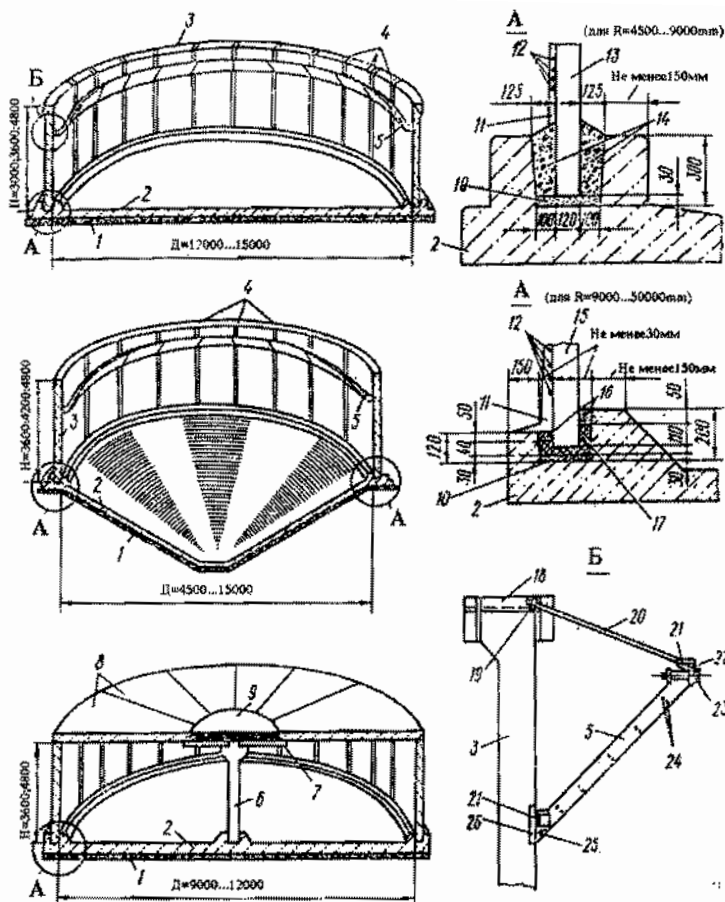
Конструктивно-монтажные схемы цилиндрических емкостных сооружений из типовых унифицированных сборных элементов и деталей: а - радиальные отстойники; б - двухъярусный отстойник или осветлитель; в - резервуар; 1 - бетонная подготовка; 2 - монолитное днище с пазами; 3 - стеновые панели; 4 - стыки между панелями; 5 - элементы лотков ЛТЗ; 6 - колонна; 7 - поддерживающий элемент; 8 - плиты покрытия; 9 - монолитная круглая плита; 10 - выравнивающий слой цементного раствора; 11 - защитный слой торкрета; 12 - предварительно напрягаемая кольцевая арматура; 13 - стеновые панели типа СПЦ1; 14 - бетон марки М300 на мелком заполнителе; 15 - стеновые панели ПСЦ-2 (при  $R = 9 \dots 18$  м) или ПСЦ3 (при  $R = 24 \dots 50$  м); 16 - асбестоцементный раствор; 17 - битум марки БНПБ; 18 - хомут из уголка 80х6; 19 - гайка; 20 - монтажная тяга Ж16; 21 - сварной плов; 22 - уголок 80х6; 23 - болт  $d = 10$ ; 24 - выпуски арматуры; 25 - монтажные столики из уголка 100х10; 26 - закладные детали
